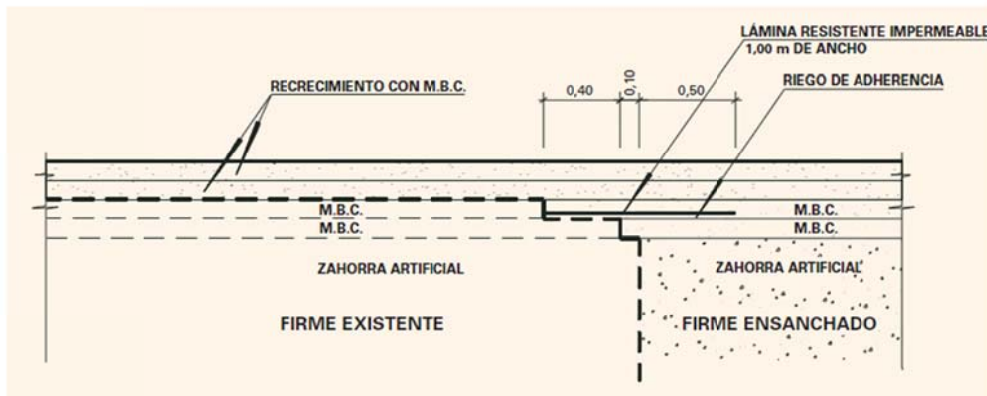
ESQUEMA DE SECCIÓN TIPO DE ENSANCHE DE FIRME
